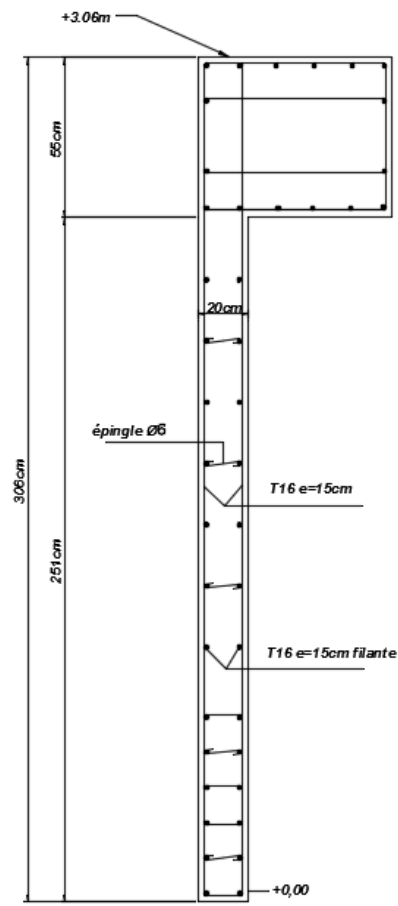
Coupe verticale du ferrailage voile périphérique.
